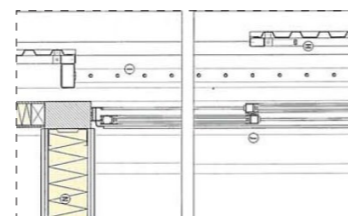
Detalle constructivo 2. Planta de envolvente opaca. Espacio aislado y calefactado.
